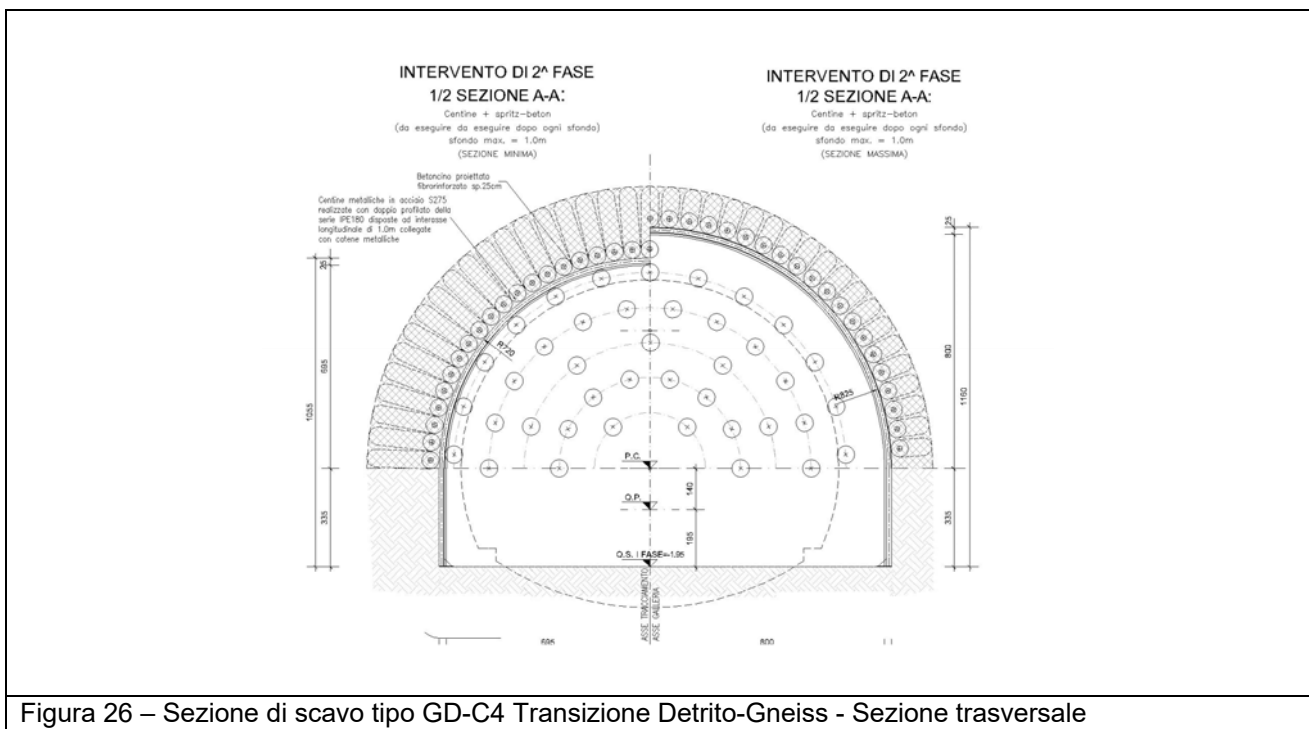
Sezione di scavo tipo GD-C4 Transizione Detritite-Gneiss - Sezione trasversale
